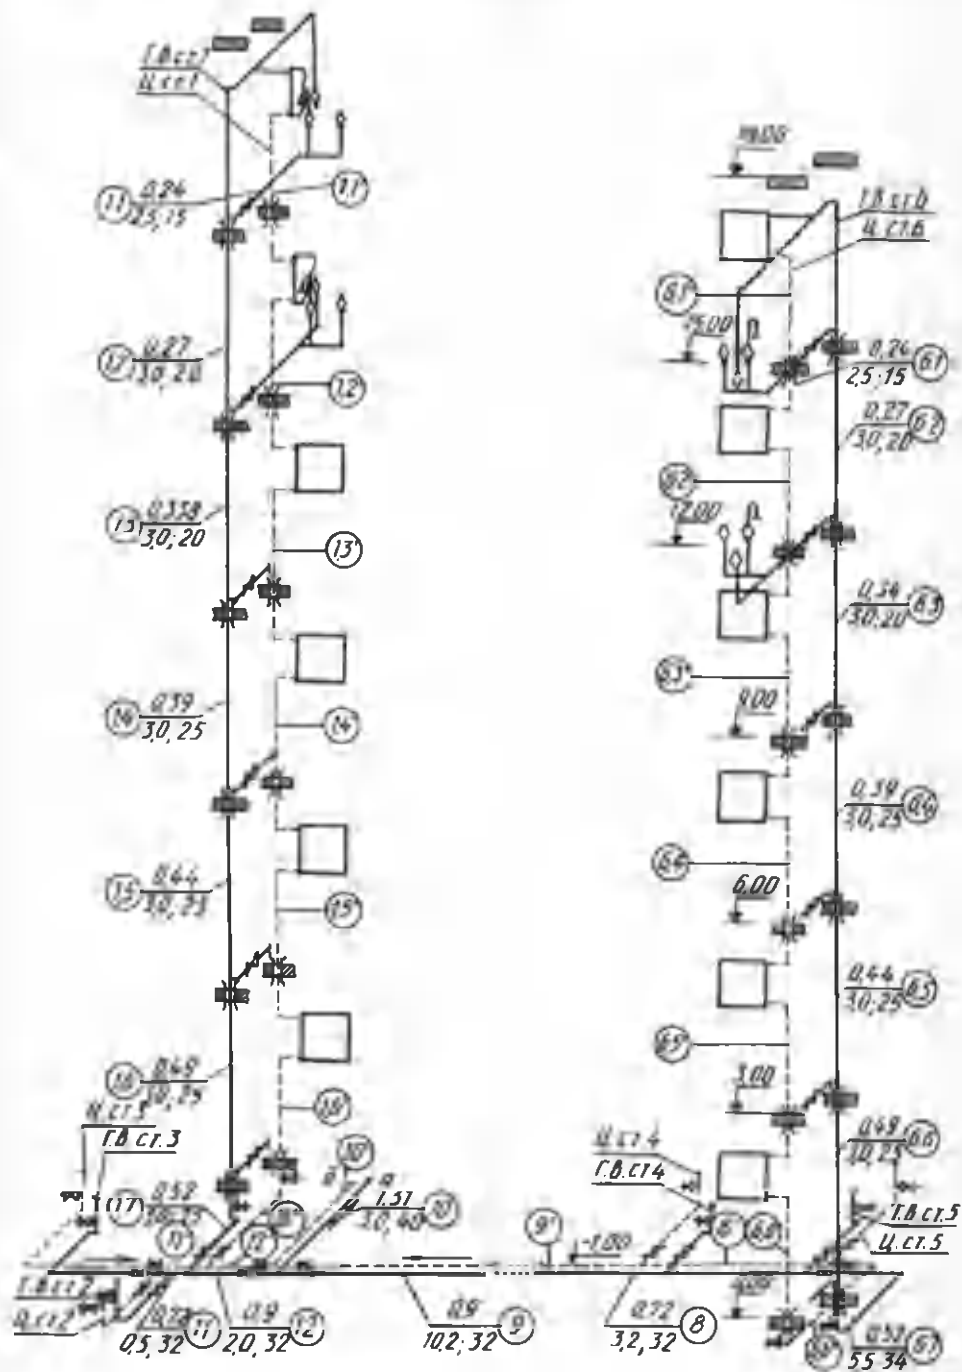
Аксонометрическая схема теплопроводов системы горячего водоснабжения
